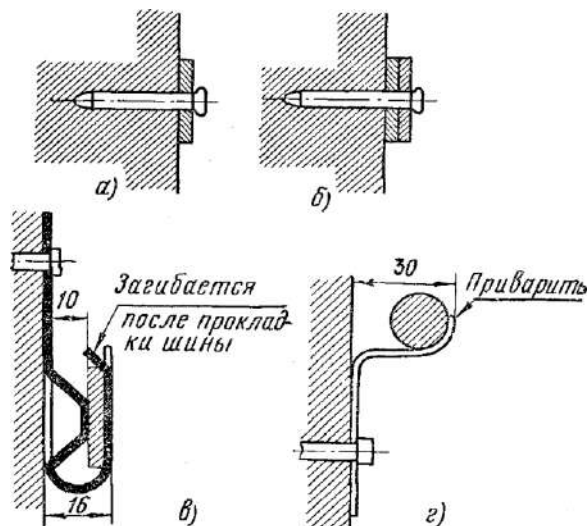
Крепление заземляющих проводников дюбелями с помощью строительно-монтажного пистолета (а — непосредственно к кирпичному или бетонному основанию, б — с прокладкой) и промежуточные детали для крепления прямоугольных (в) и круглых (г) заземляющих проводников
